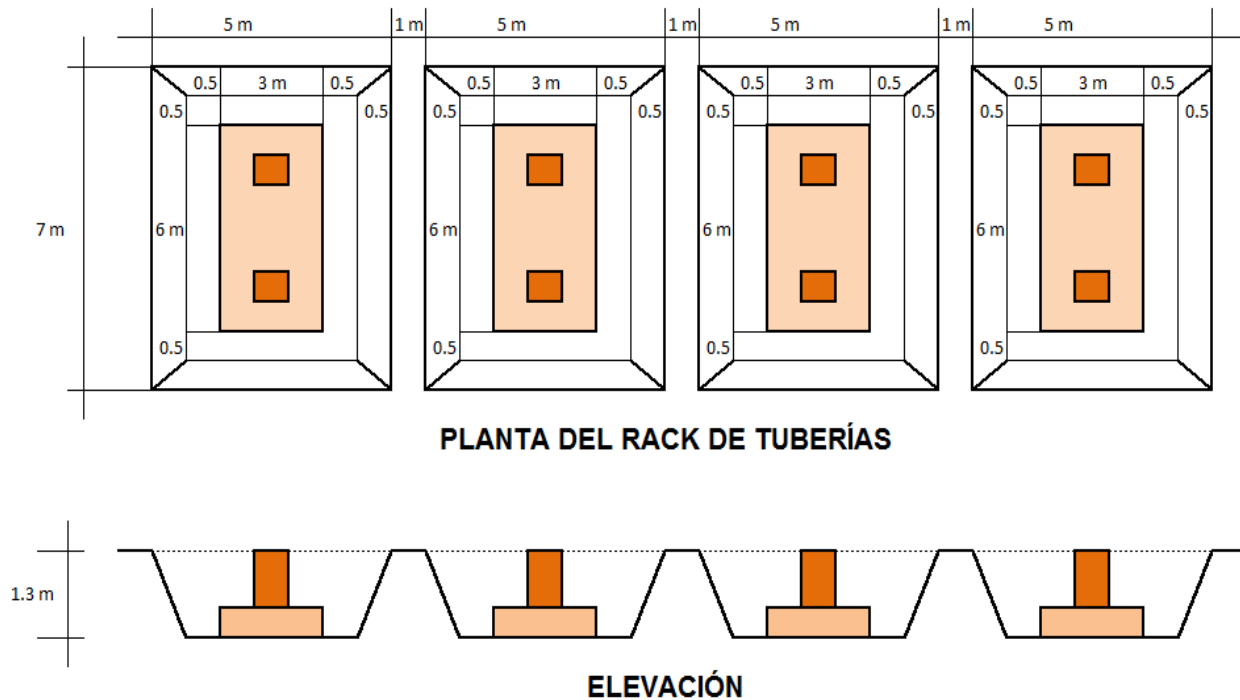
Planta y elevación de las cimentaciones del rack de tuberías
